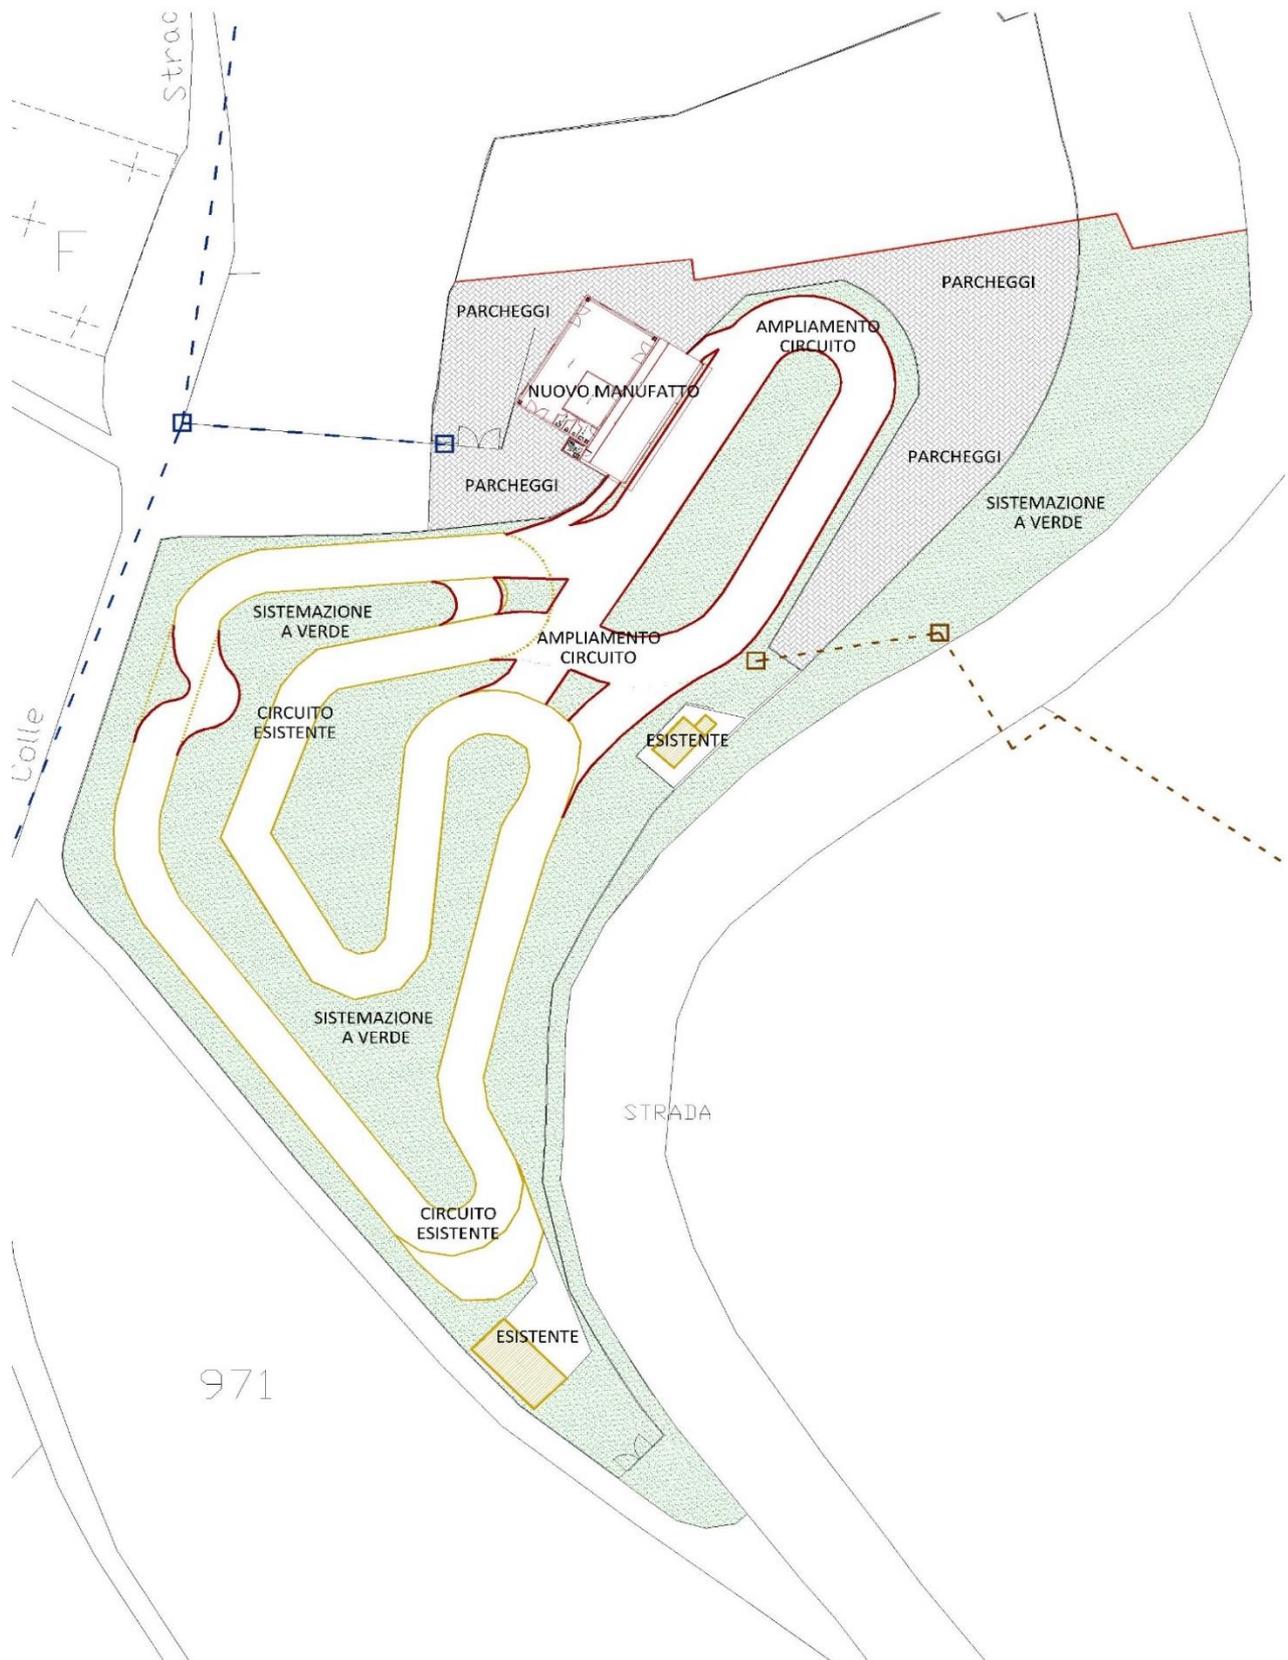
Planimetria generale dell'intervento in progetto con zonizzazione e destinazioni d'uso
